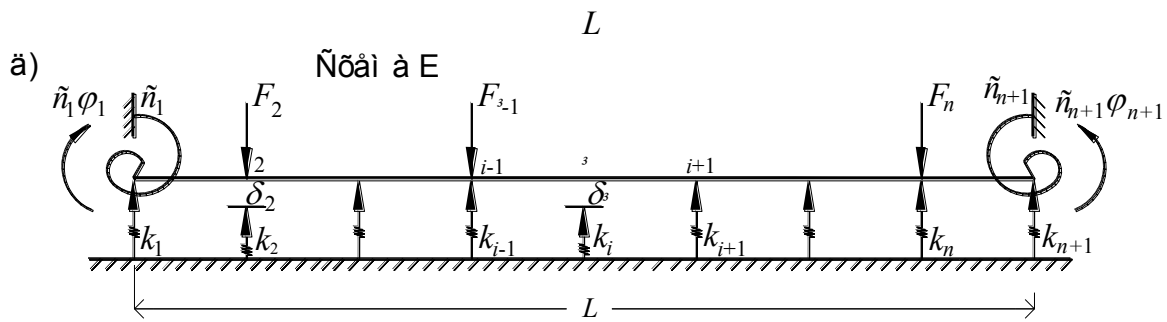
Расчетная схема железобетонной конструкции на деформируемом основании
